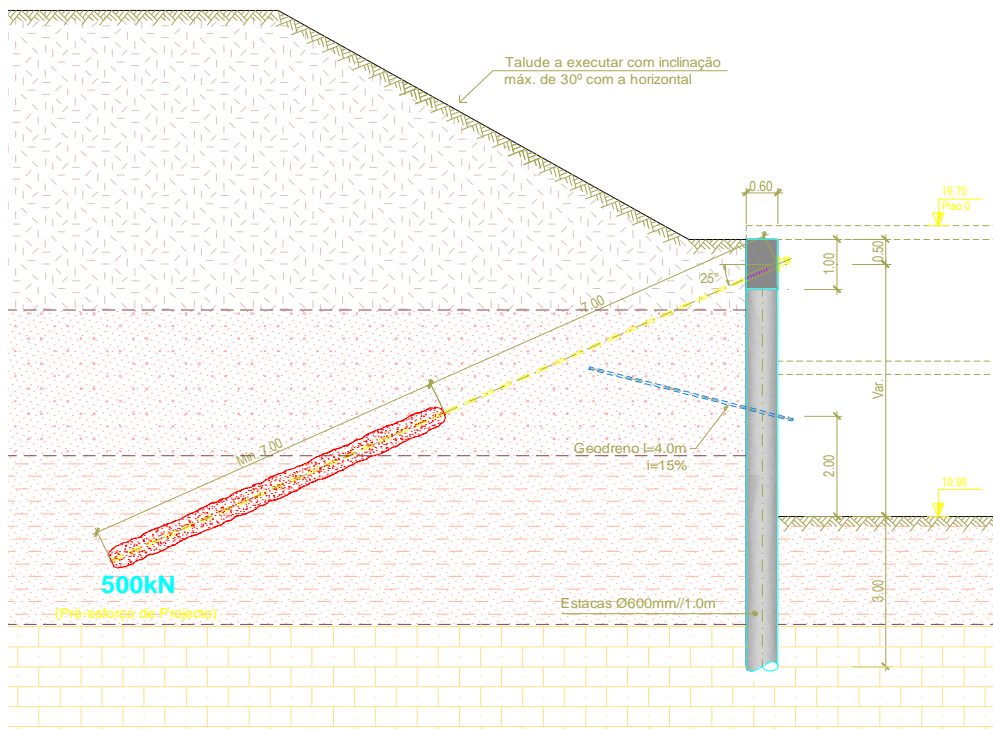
Corte Tipo 2: segundo nível de ancoragens e drenos sub-horizontais.
